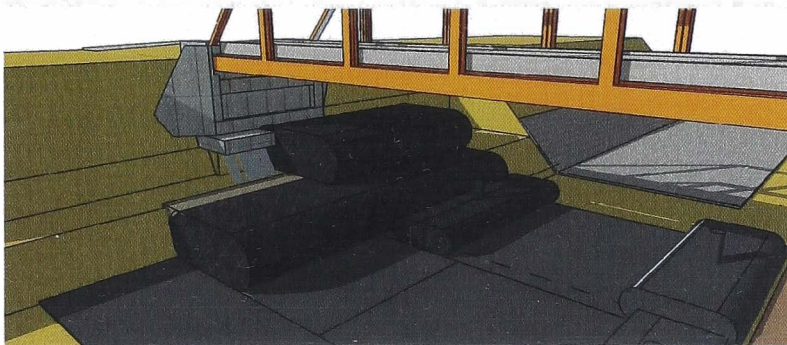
Colocación del siguiente nivel de la geoestructura.
